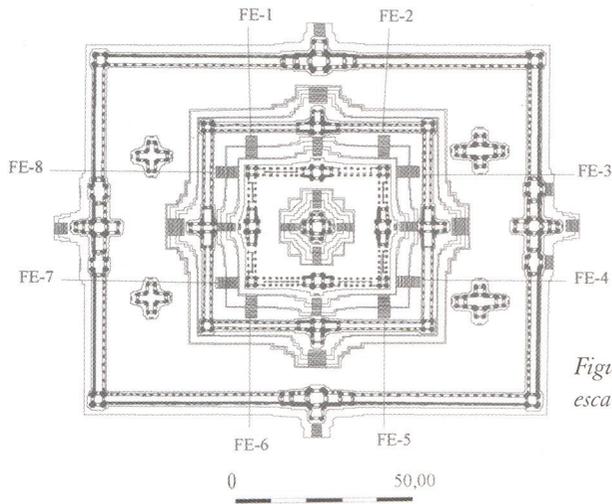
Plan du Baphuon et emplacement des faux escaliers.
